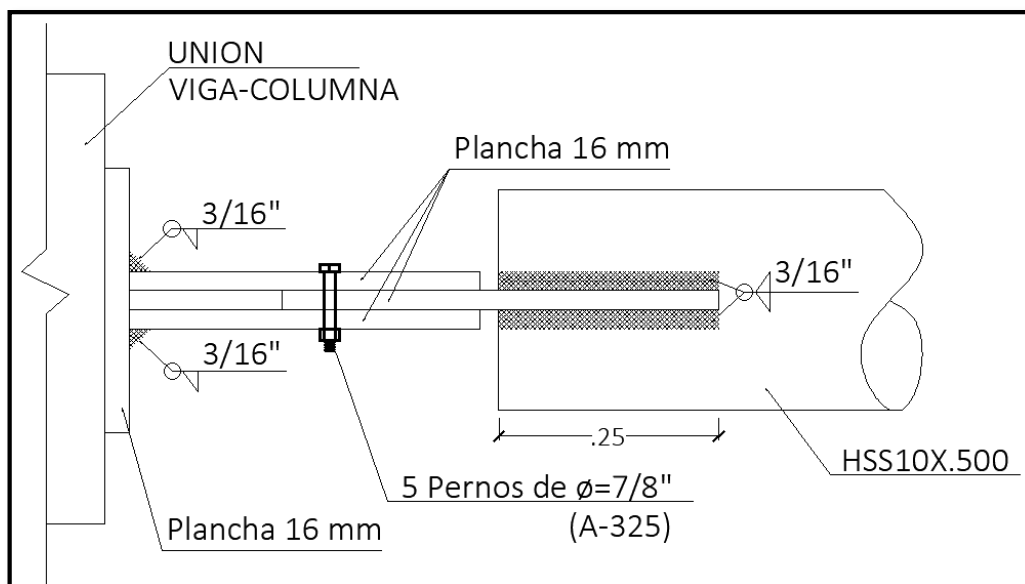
Corte longitudinal de detalle 2. (Fuente: Elaboración propia)
